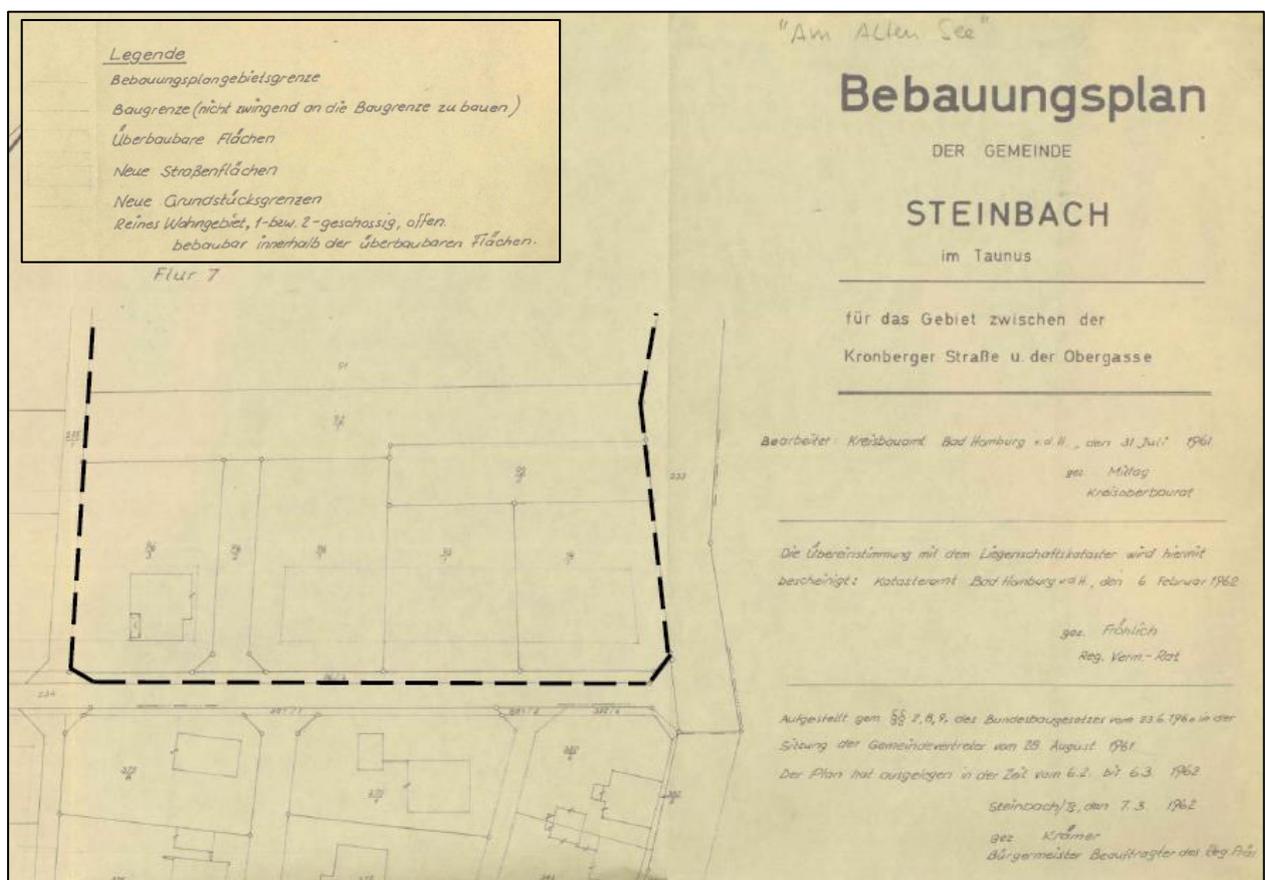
Auszug aus dem Bebauungsplan von 1962 (nördlich Staufenbergstraße) mit räumlichem Geltungsbereich des Bebauungsplans „Obergasse / Rombergstraße“ (schwarz gestrichelt)
